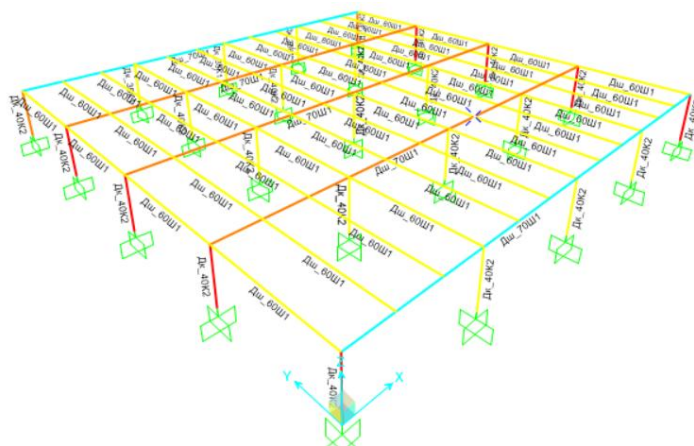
Расчетная схема с подобранными сечениями в среде SAP2000
